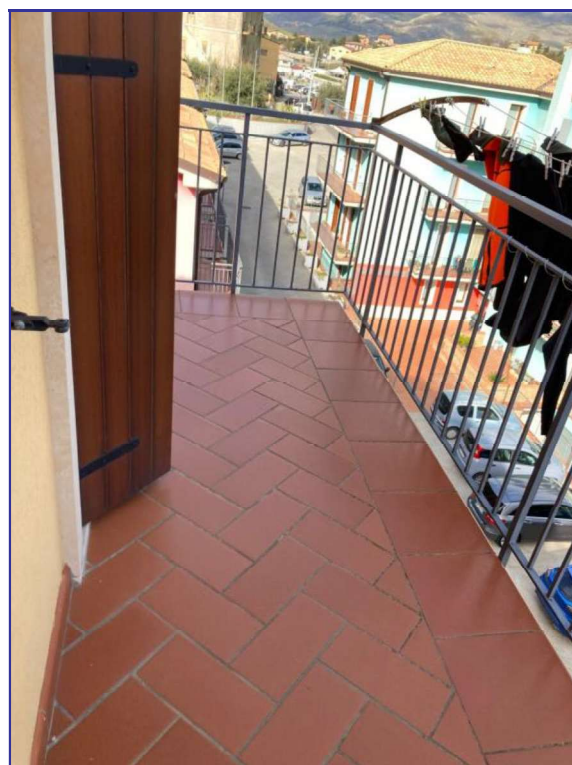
Imm. 1 - A sinistra il balcone esterno da affaccio per il soggiorno/cucina e cameretta n. 2 a destra balcone della cameretta n. 1.
